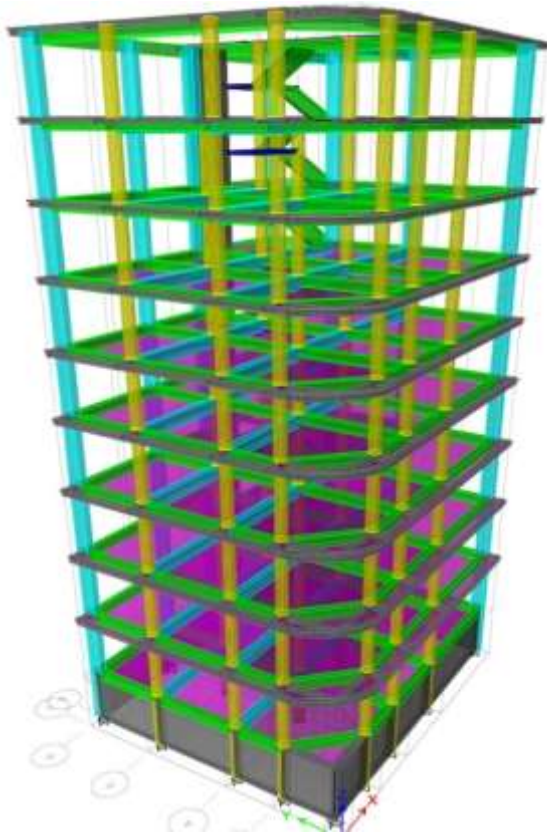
Vista en 3D de la estructura con asignación de elementos estructurales.
